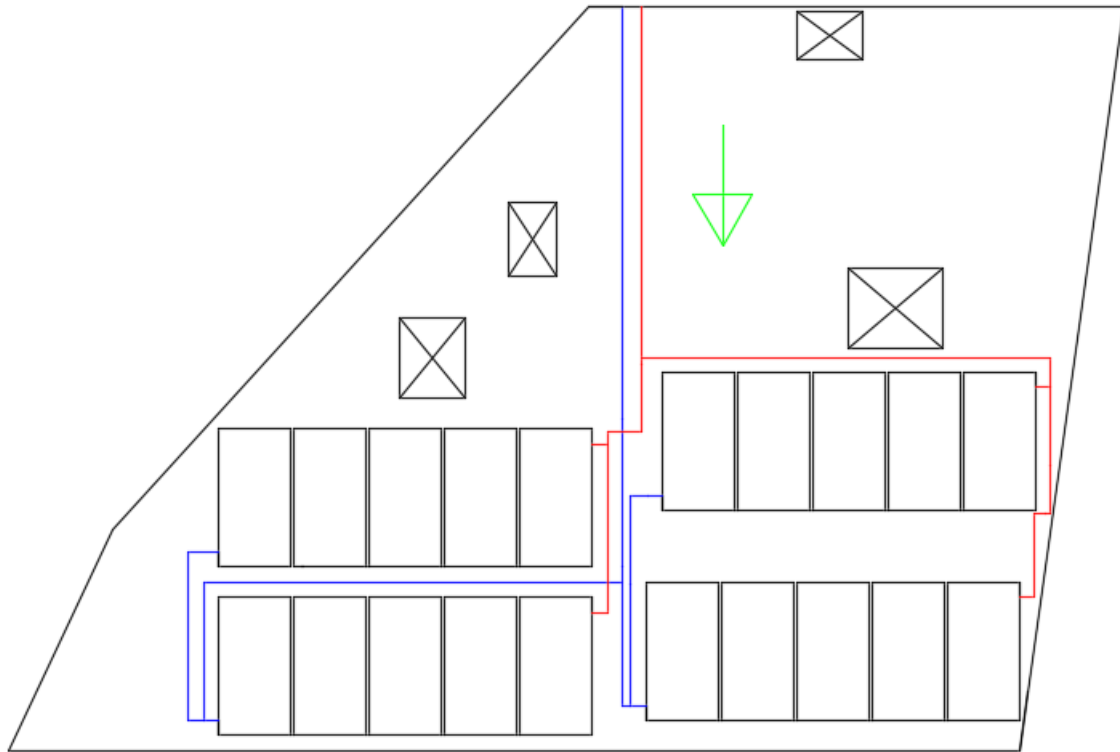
Layout del campo solar de captadores planos [AutoCAD]
